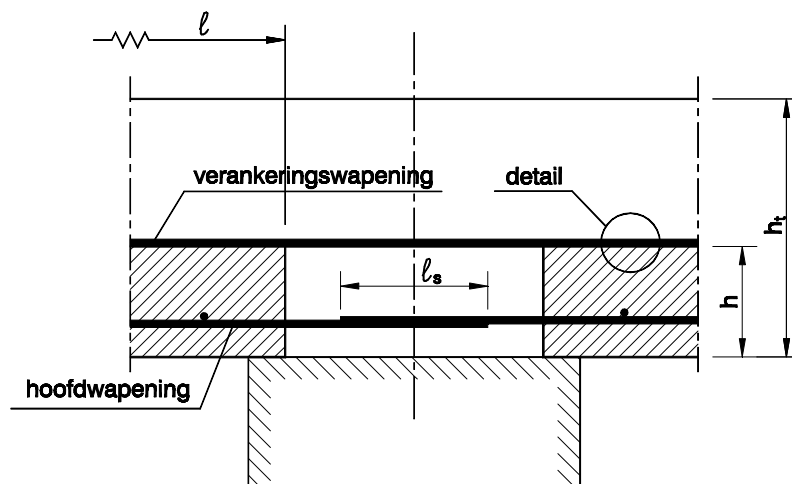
b - Verankering van de hoofdwapening met opgebogen uitstekende wapening ter plaatse van een oplegging
